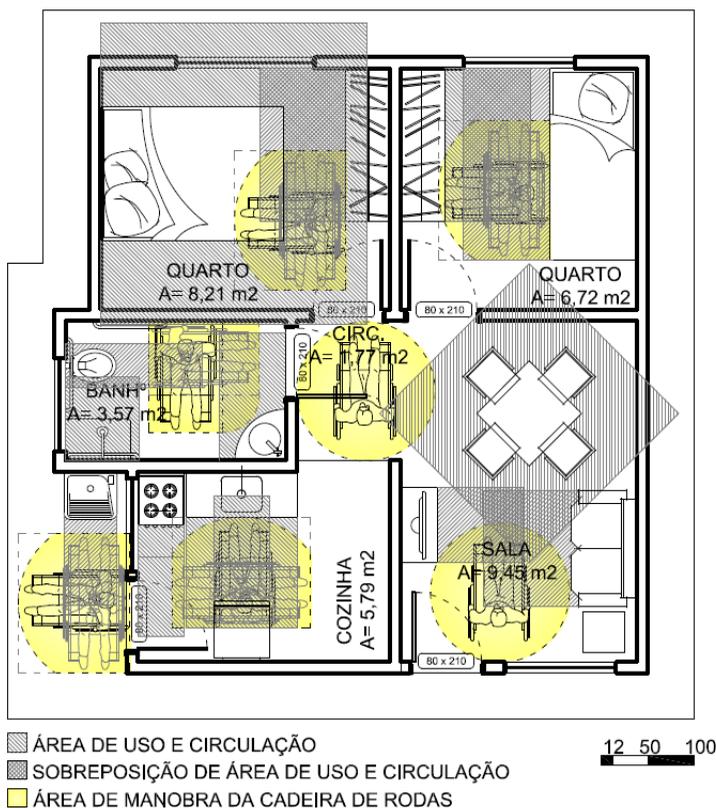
Conjunto 4 – Planta baixa da UH tipo 2.
